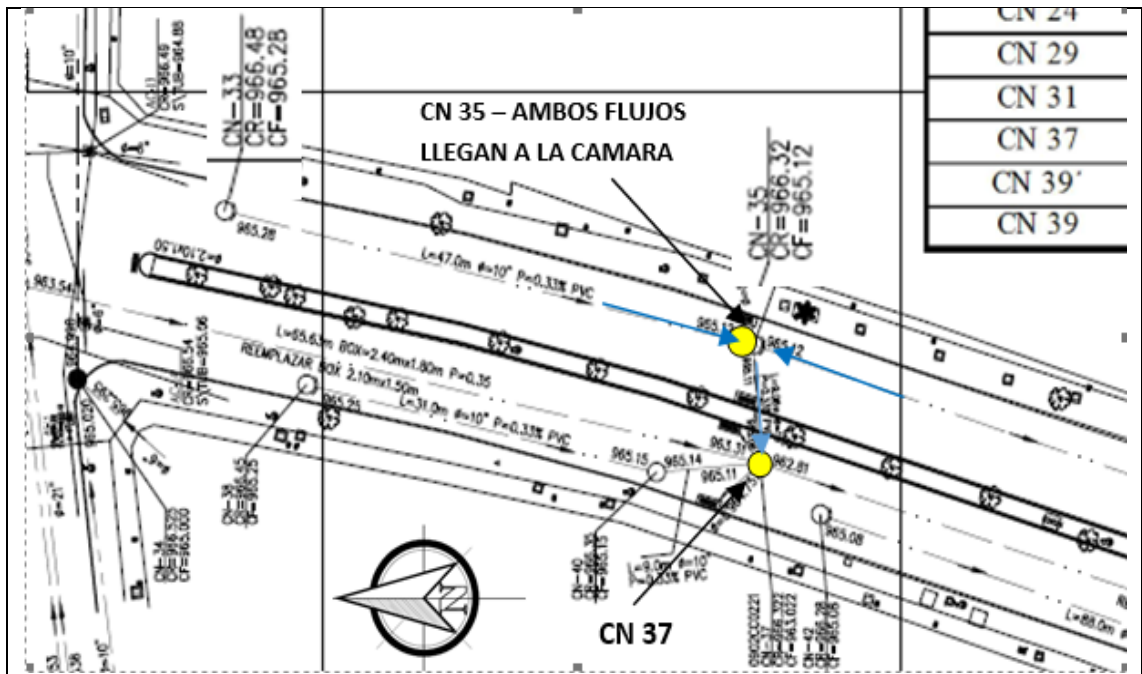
Ubicación en planta de las cámara tipo B CN35 y CN37
